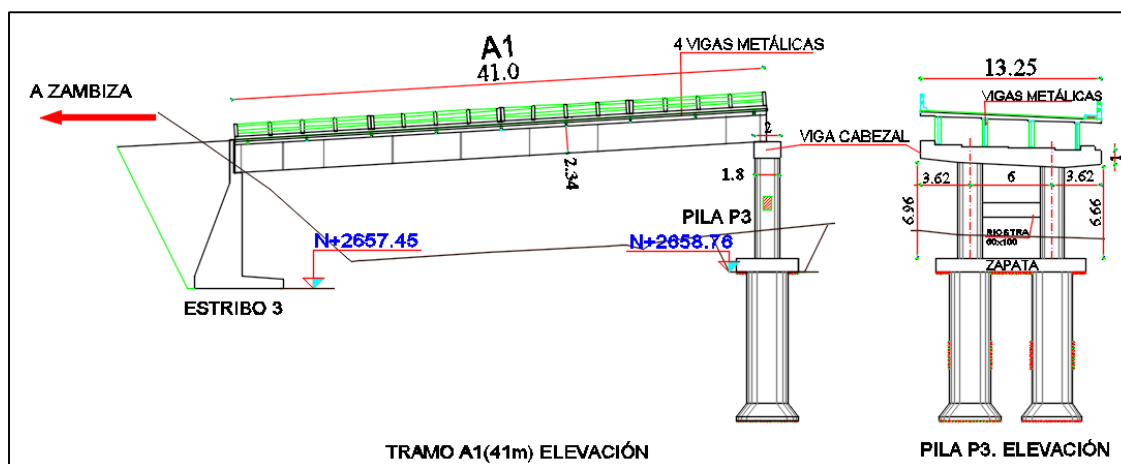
Tramo A1 (41m) y Pila P3 en elevación
